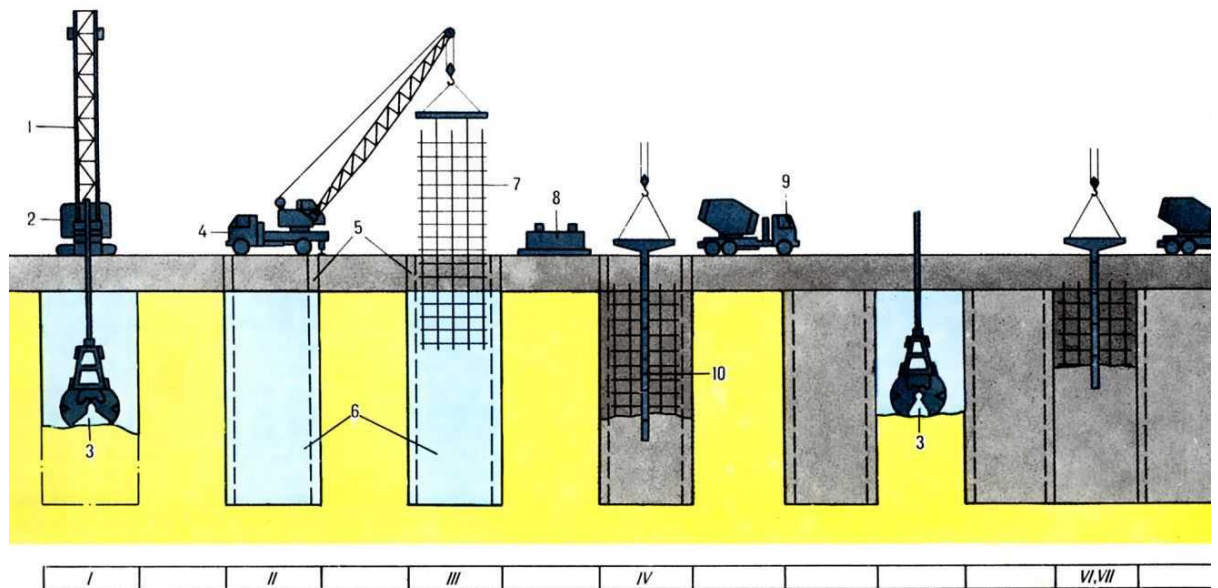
Технологічна схема улаштування стіни у ґрунті: 1 – розробка траншеї на довжину захватки; 3 – установа обмежувачів (розділюючих захватки); 3 – монтаж арматурних каркасів; 4 – бетонування на захватці методом вертикального переміщення труби
